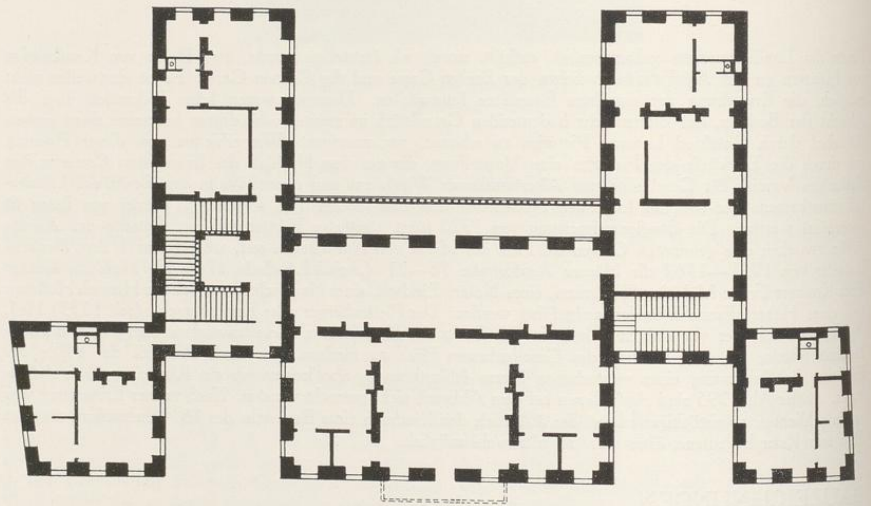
Grundriß des Obergeschosses des Nordkirchener Hofes, zweite Variante
